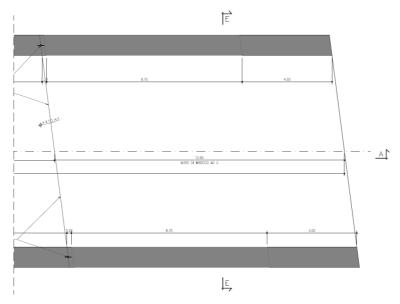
Muri d'imbocco - Pianta inferiore
